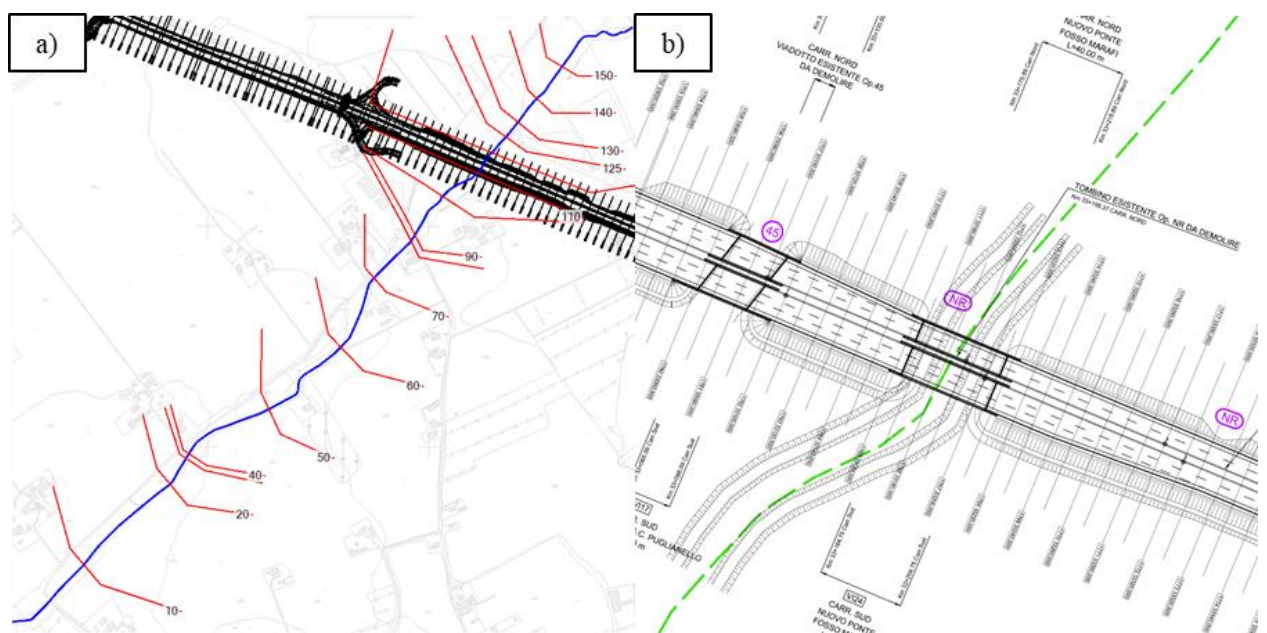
Inquadramento planimetrico della nuova opera VI24: a) sezioni modellate (planimetria modello idraulico), b) planimetria dell'inalveazione del vallone
